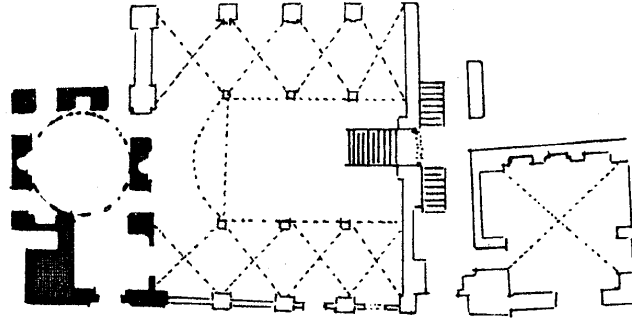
مسقط أفقي للقبة بتكية،
